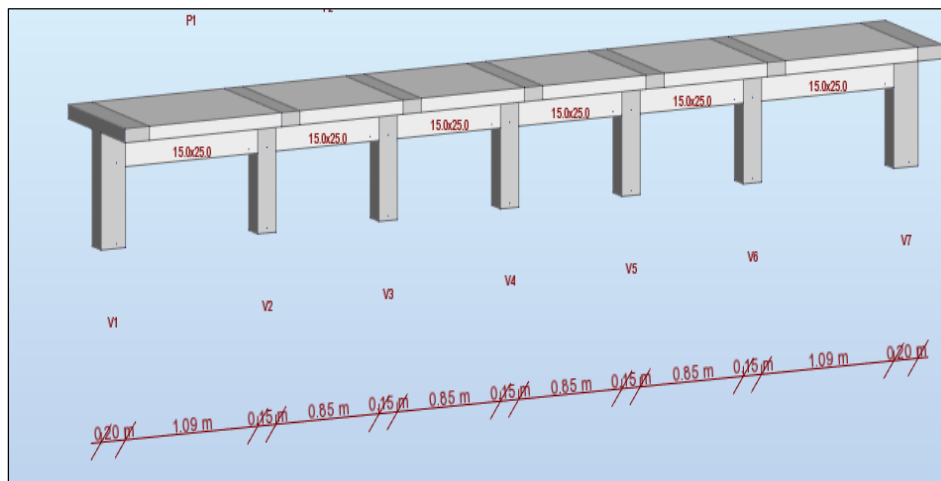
Modelo de la vigueta continua VLN-01. Correspondiente a la losa nervada 01.
